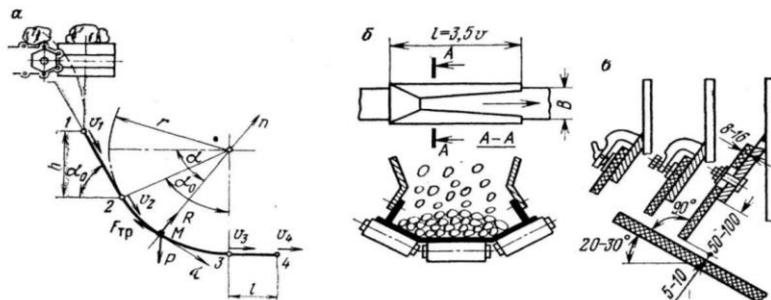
Конструкция загрузочного лотка: а - профиль лотка; б- направляющие борта; в - варианты установки нижней кромки бортов
